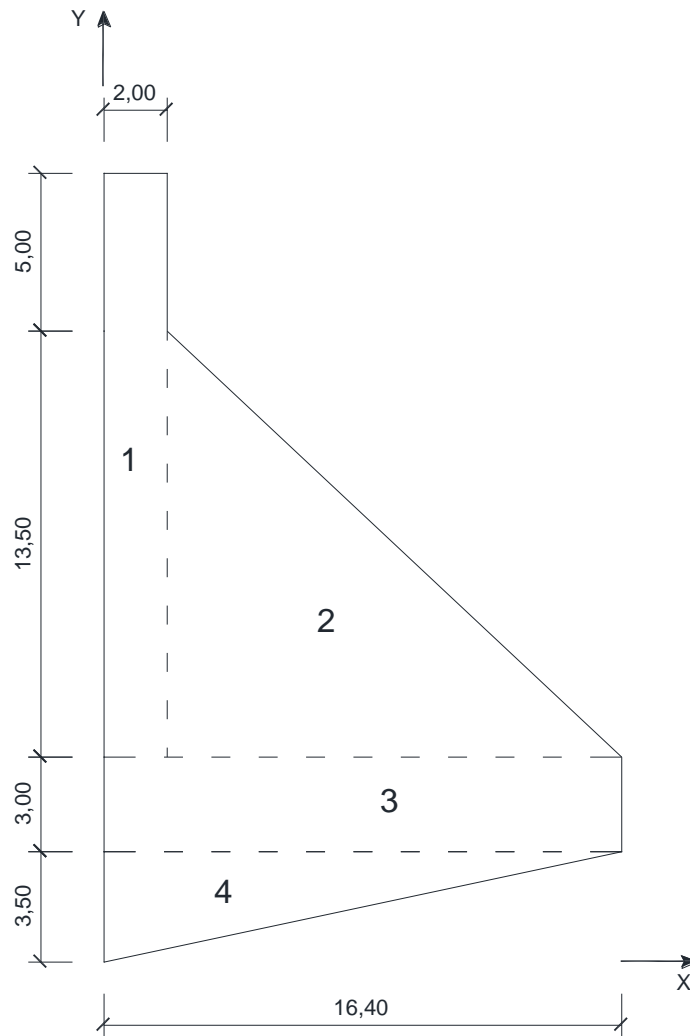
Subdivisão da geometria da secção da barragem.
